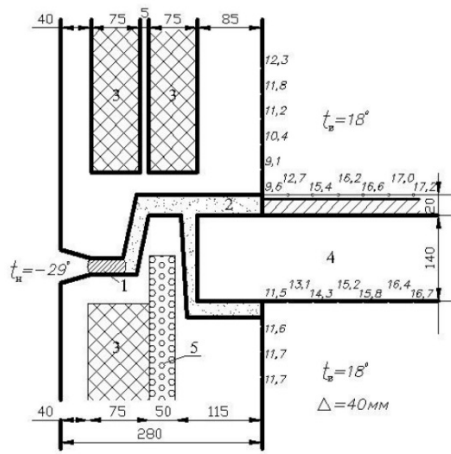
Температуры внутренней поверхности горизонтального стыка железобетонных панелей наружных стен: 1 — гернит; 2 — цементный раствор; 3 — фибролит; 4 — железобетонная плита междуэтажного перекрытия; 5 — пенополистирол
